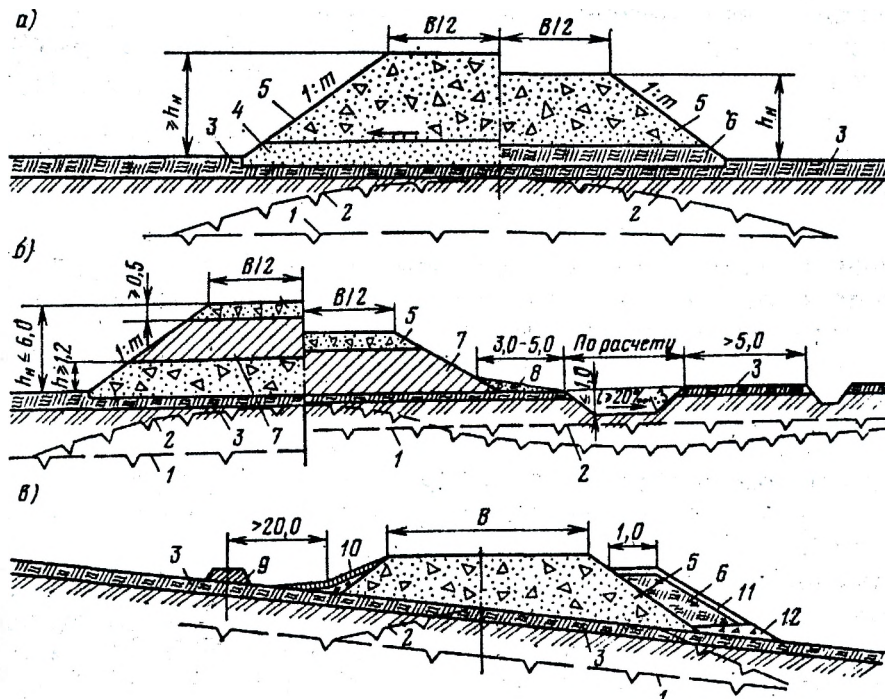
Поперечные профили насыпей на льдонасыщенных основаниях в зоне распространения вечномерзлых грунтов: а – из дренирующих грунтов на льдонасыщенном основании с устройством защитного дренирующего слоя из песка или мелкого гравия либо теплоизоляционного слоя из мха; б – с использованием местного глинистого грунта; в – на пологом косогоре с уклоном менее 1:5; 1 – верхний уровень вечномерзлых грунтов до отсыпки насыпи; 2 – то же, после отсыпки насыпи; 3 – моховой покров; 4 – защитный слой из мелкого дренирующего грунта; 5 – песчано-гравийный грунт; 6 – теплоизоляционный моховой слой; 7 – глинистый слой; 8 – берма; 9 – нагорный валик; 10 – укрепление мощением; 11 – защитный слой растительного грунта толщиной 15 см; 12 – дренирующая присыпка
